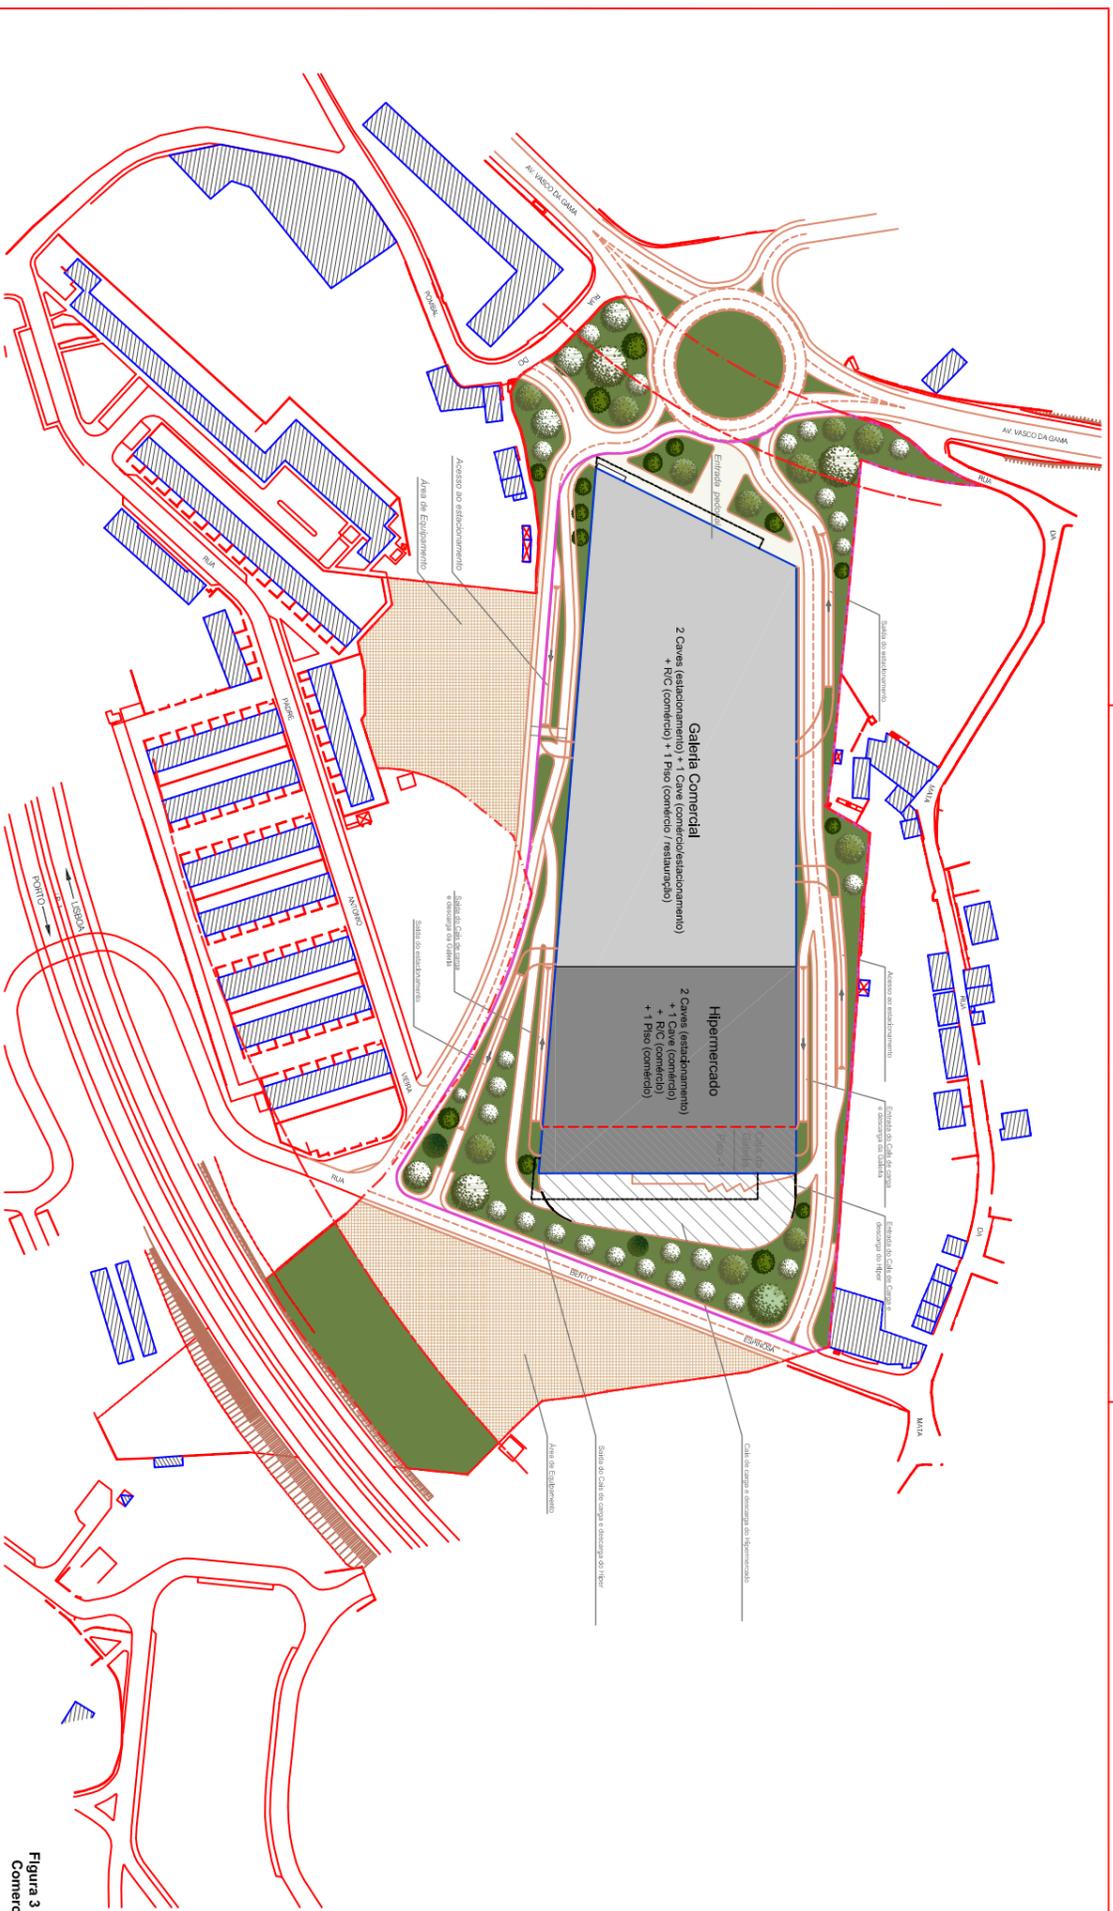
Planta Síntese do Centro Comercial de Vila de Andorinho
